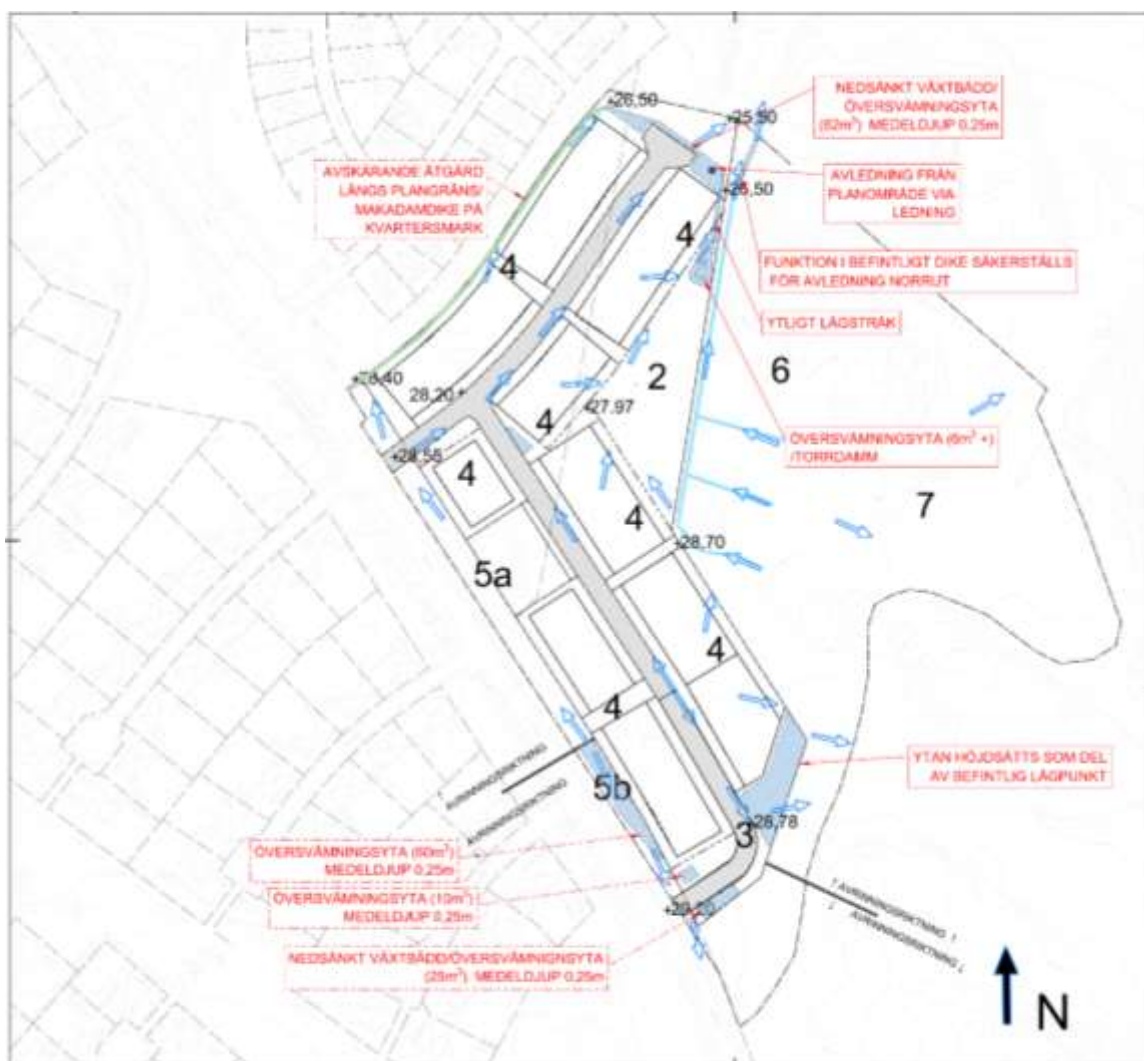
Föreslaget svackdike med dämmen norr om planområdet.
